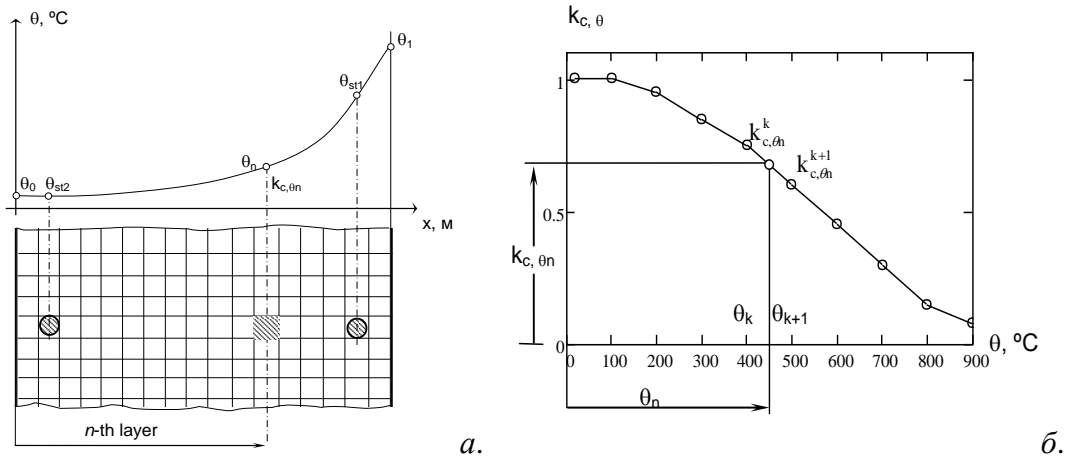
Обчислення коефіцієнту зниження міцності бетону залізобетонного ригеля за температурою у внутрішньому шарі: а – схема розбиття на шари перерізу залізобетонного ригеля; б – схема лінійної залежності коефіцієнту зниження міцності бетону залізобетонного ригеля за табличними даними
